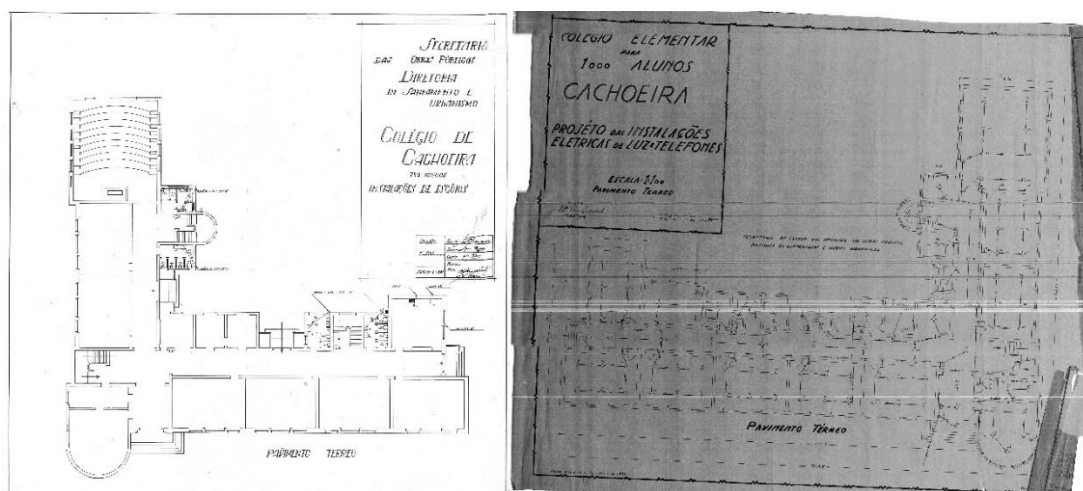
Planta pavimento térreo, 750/1000 alunos I.E.E. João Neves da Fontoura. Cachoeira do Sul/RS
